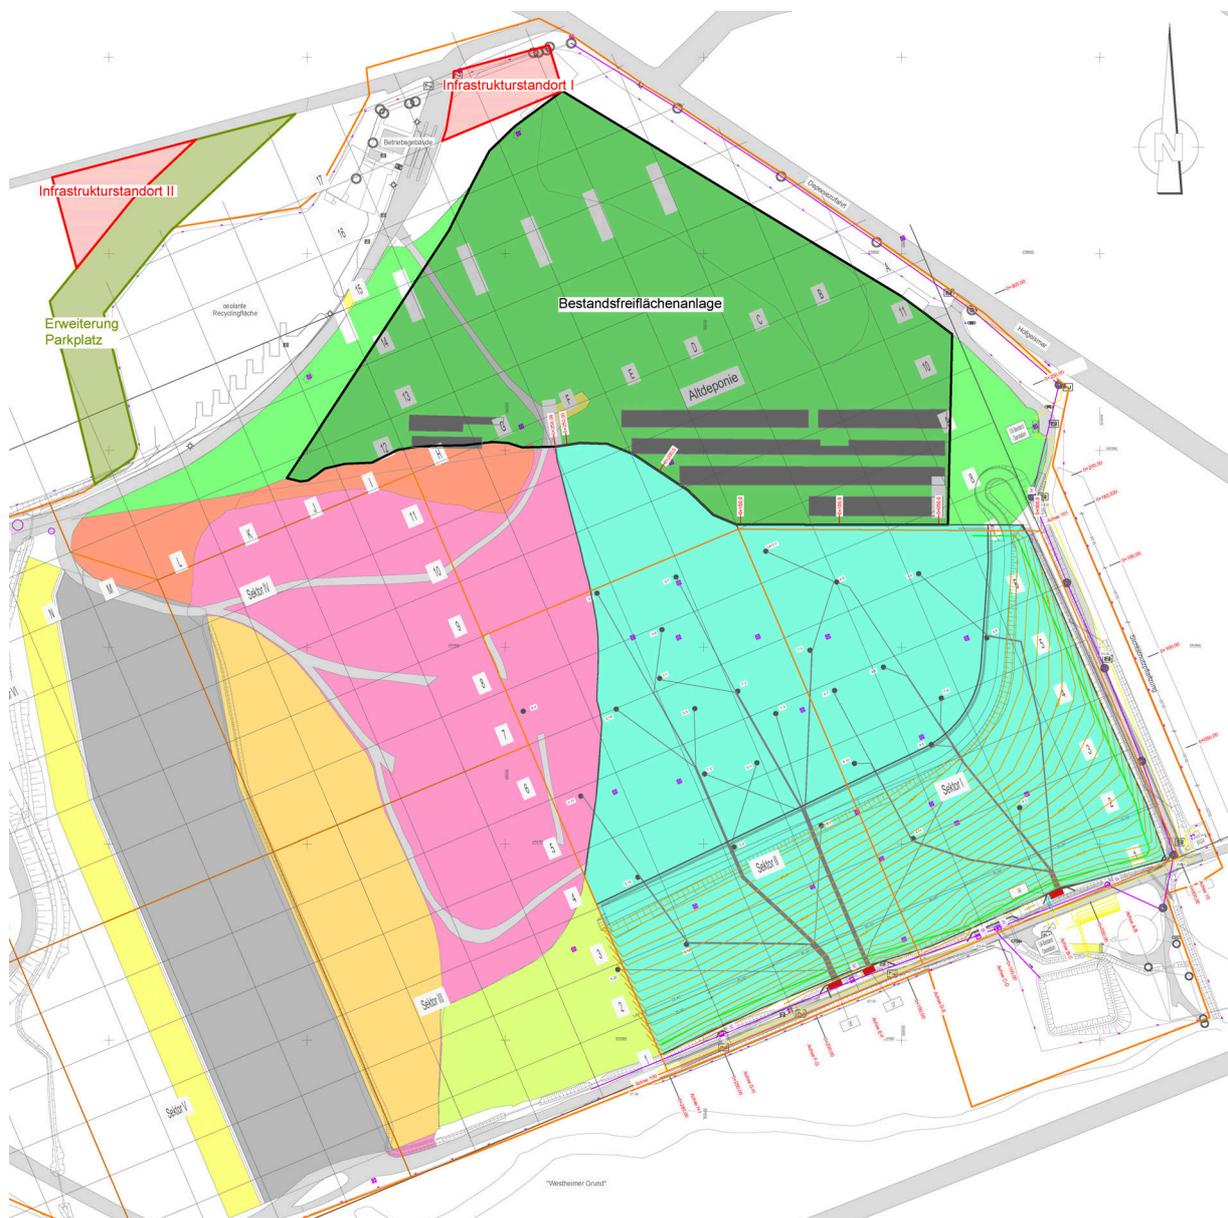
Bestandslageplan Deponie Kirschenplantage, Stand 09/24 (Quelle: SIG-Hessen Ingenieure, ohne Maßstab)
